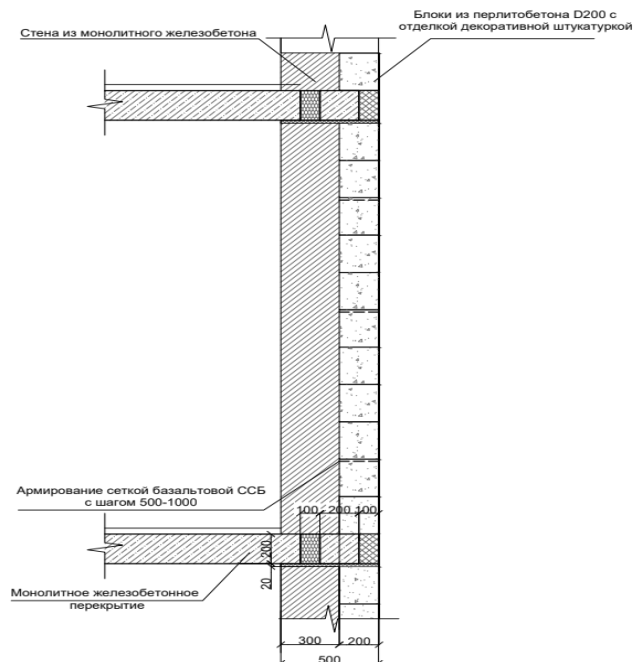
Применение перлитобетона в качестве теплоизоляционного слоя в наружной стене.
